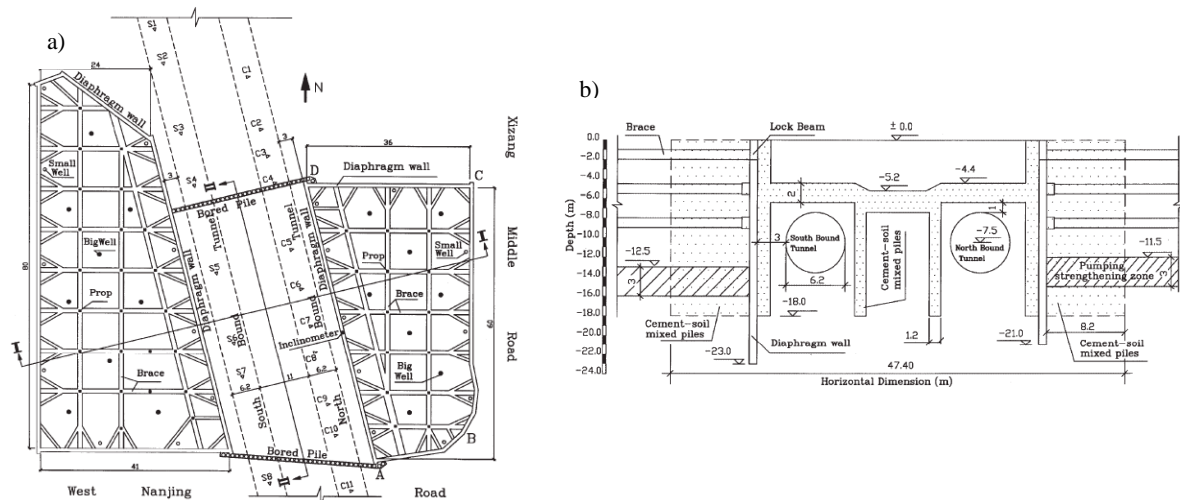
a) Planta esquemática, b) Seção esquemática dos túneis e da escavação (Hu et al., 2003).
